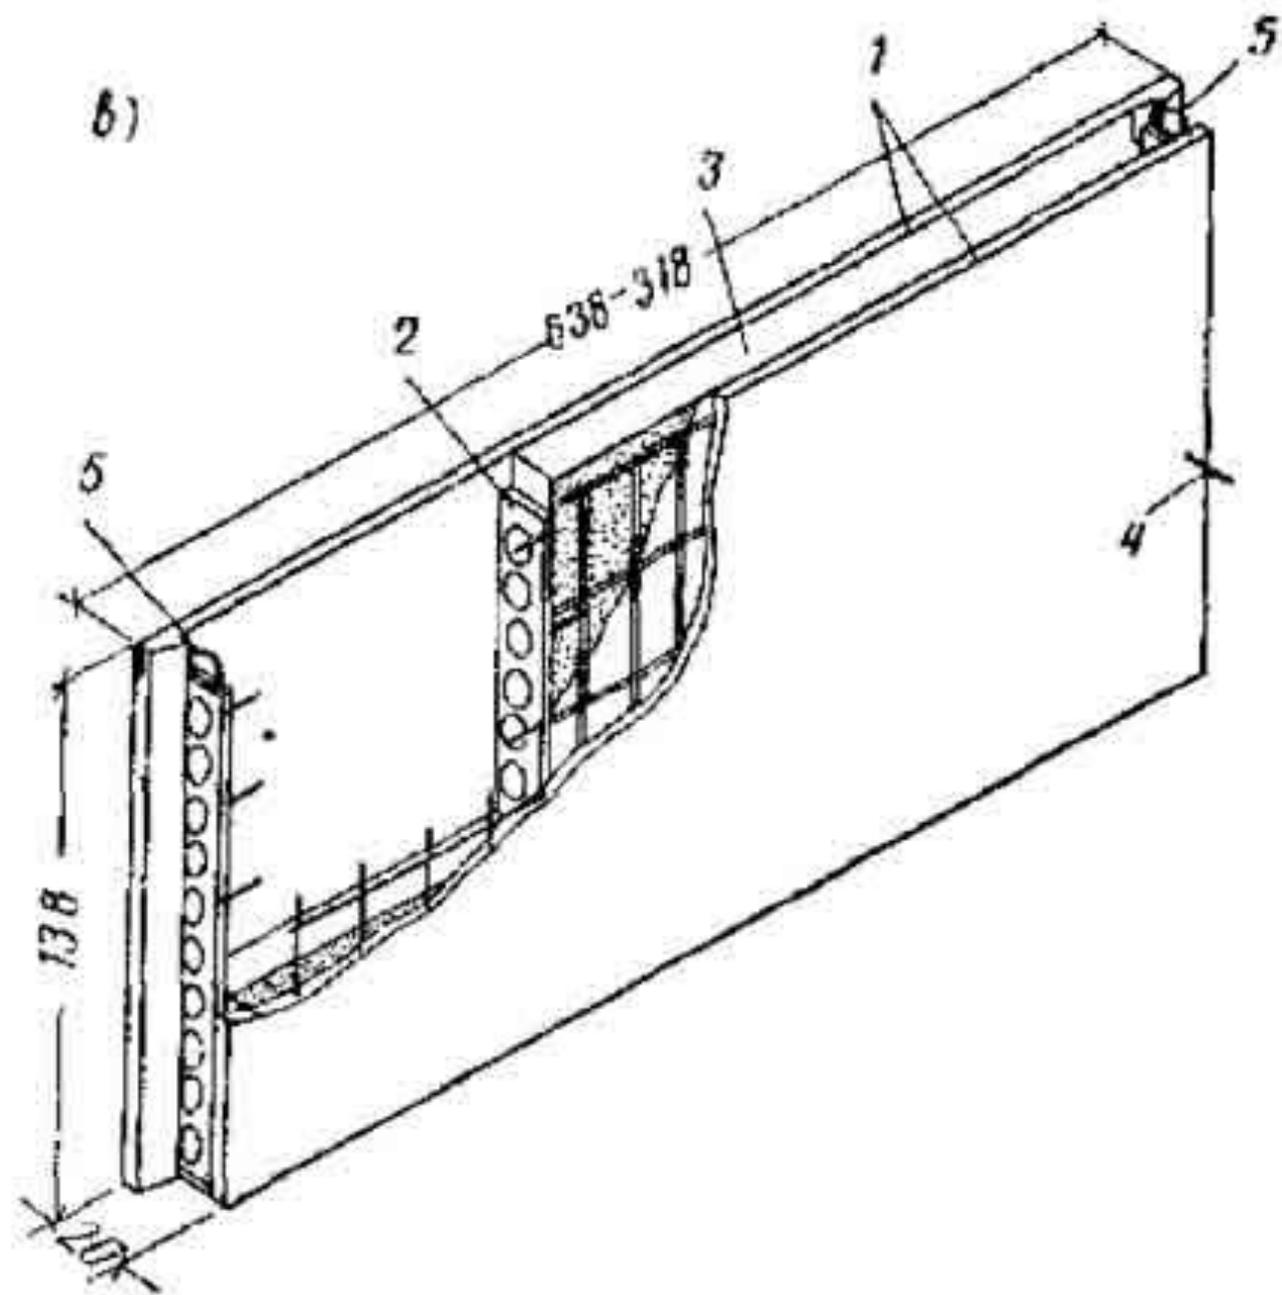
Схема армирования трехслойной панели с гибкими связями из отдельных стержней: 1 - каркас перемычки; 2 - подвеска; 3 - распорка; 4 - арматурная сетка наружного слоя; 5 - подкос
